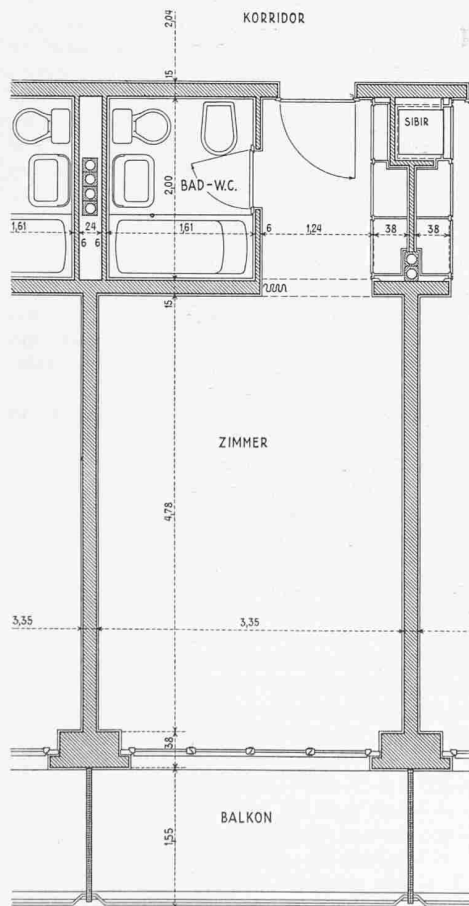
Hotelzimmer mit Balkon und Toiletten, Masstab 1:80
